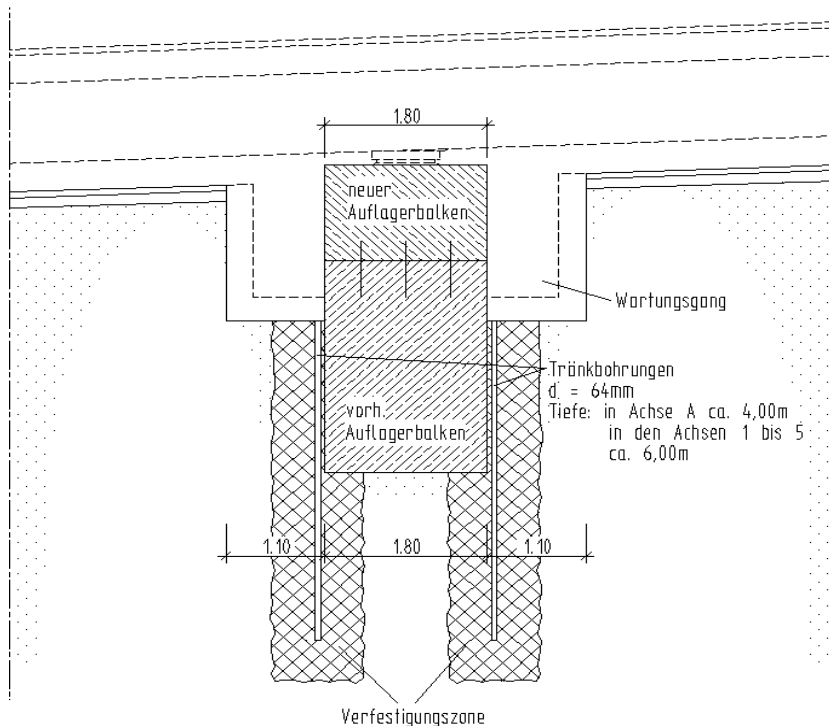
Auflagerung der Aufständering bei der Talbrücke Kleinenbremen. Tränkbohrungen neben dem vorhandenen Auflagerbalken eingebracht. Auf dem vorhandenen Auflagerbalken ist ein neuer biegesteifer Auflagerbalken aus Stahlbeton angeordnet.
